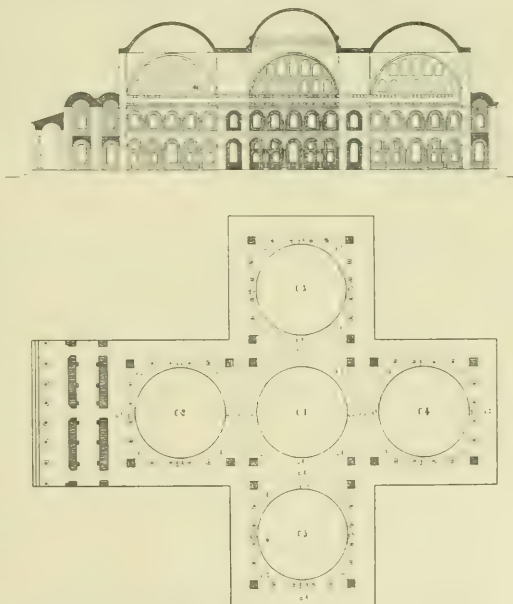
Schematische Rekonstruktion der Justinianischen Apostelkirche, Grundriß und Längsschnitt
